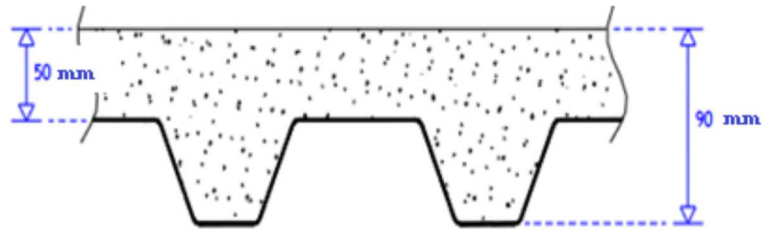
Espessuras mínimas [mm] da seção transversal de uma laje que faz parte de uma viga mista [19]
